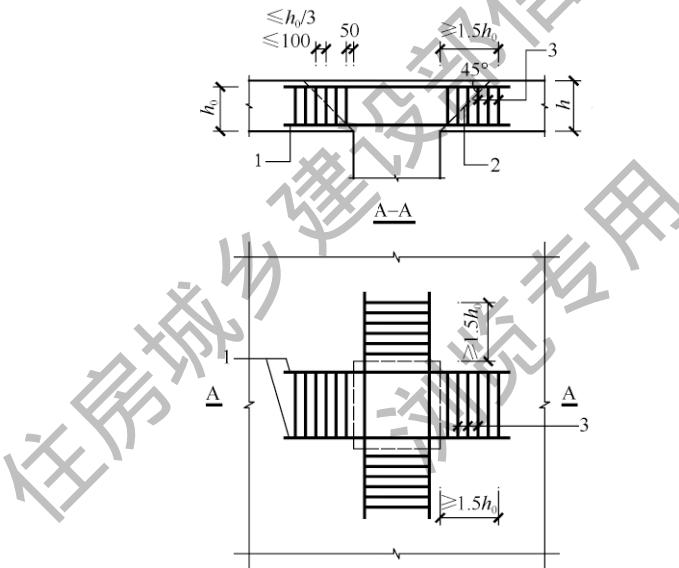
板中用箍筋作抗冲切钢筋布置示意
